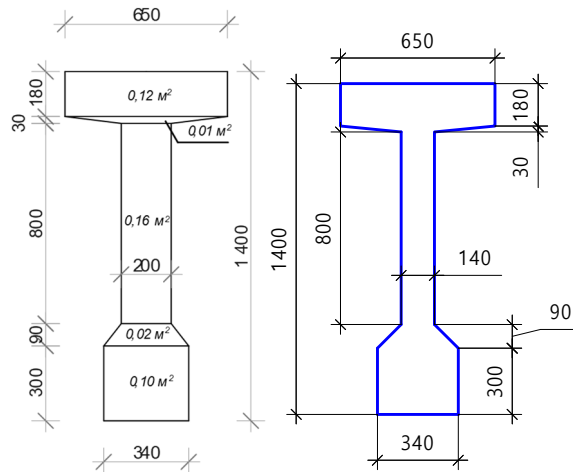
Поперечний переріз підкранової балки по середині її довжини
